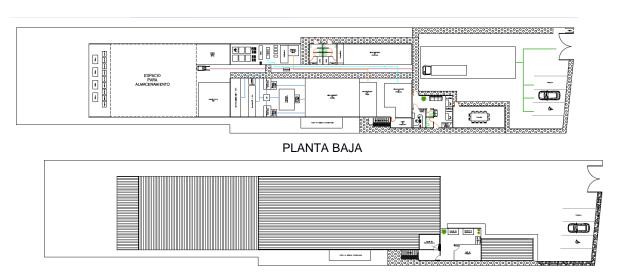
Planta Alta y Planta Baja – Propuesta de Mejora
